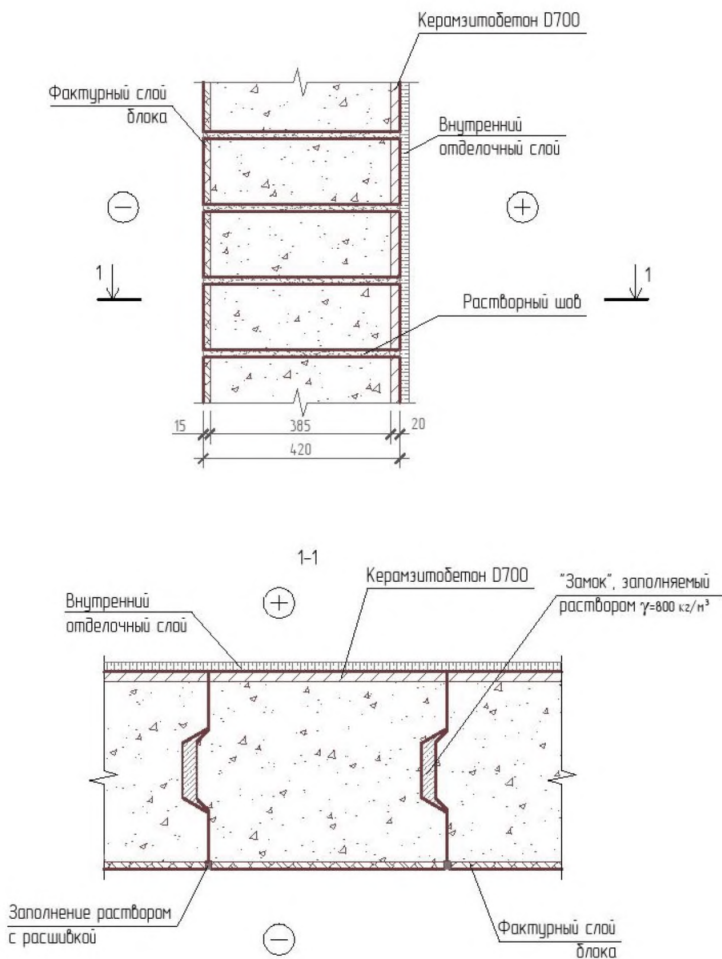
Принципиальная схема кладки наружных стен из керамзитобетонных блоков
